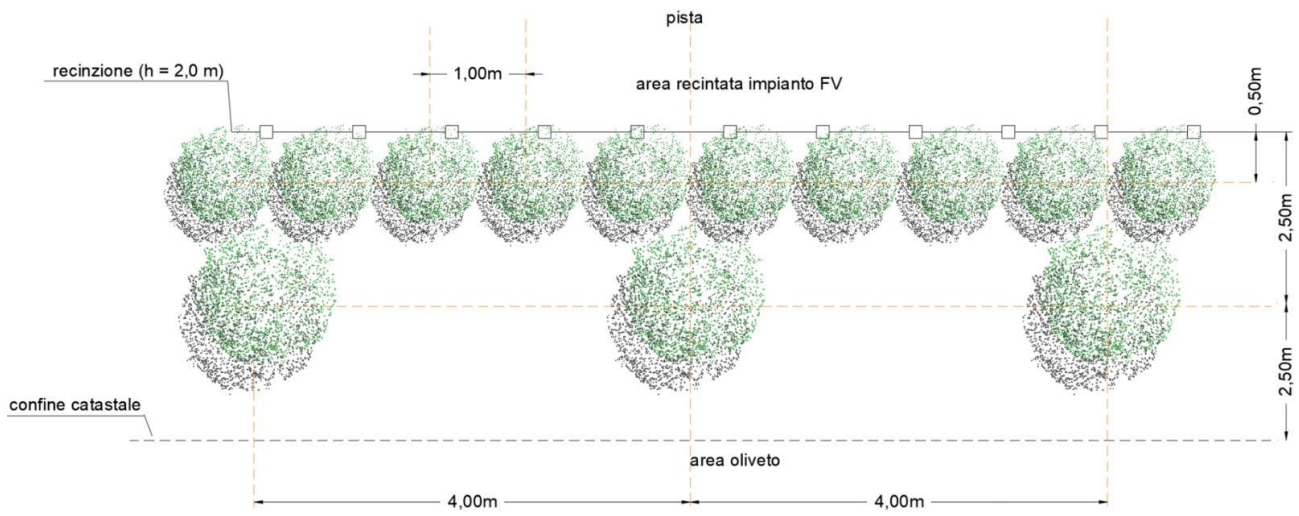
Siepe polispecifica (planimetria di progetto).
